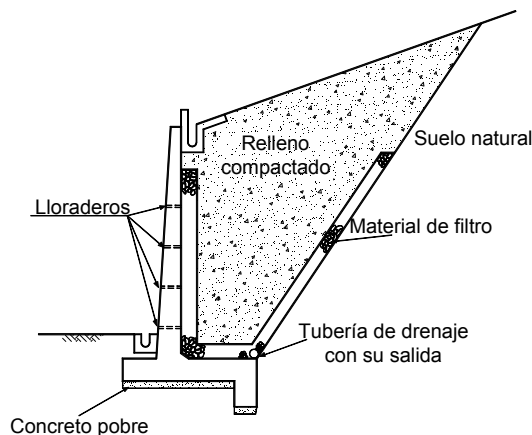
Esquema típico de un muro de concreto reforzado con su sistema de subdrenaje.
